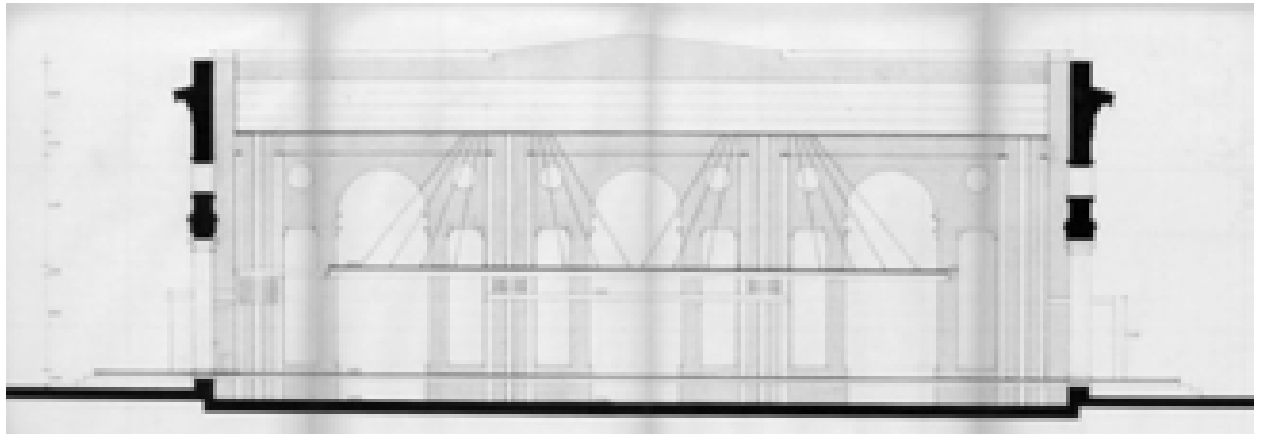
Sezione ZZ, progetto definitivo (AABS-163)
